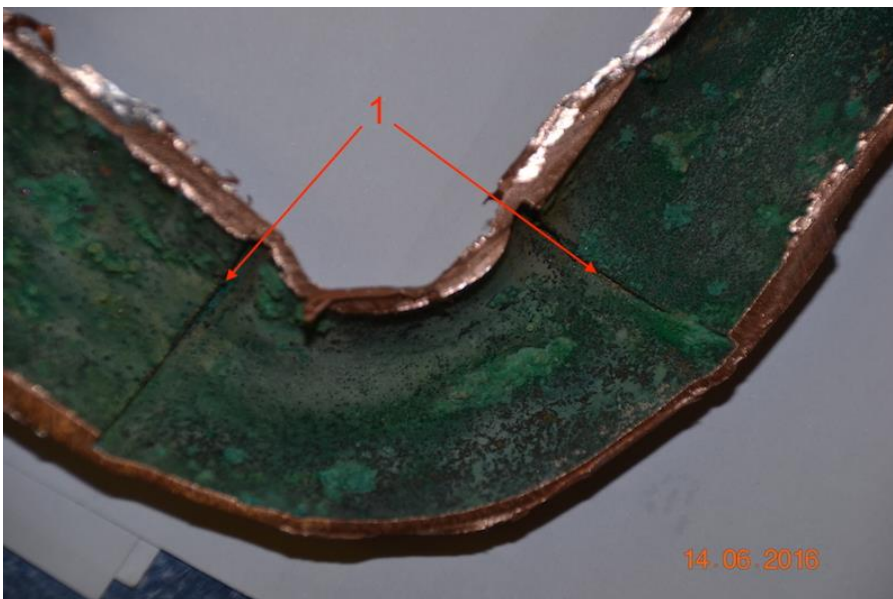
Längsschnitt einer Kupferverbindung 1 – Entgratung nicht fachgerecht
